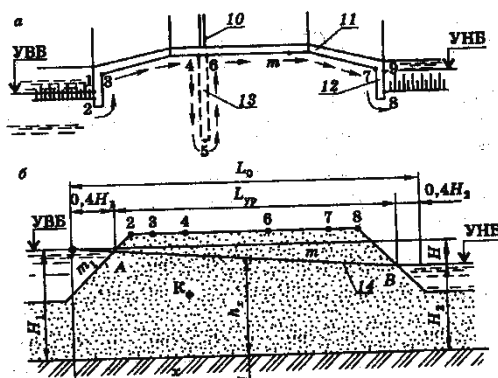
План устоя с примыкающими к нему сопрягающими стенками и с диафрагмой (а) и схема для расчетов по упрощенному методу Р.Р.Чугаева (б):
